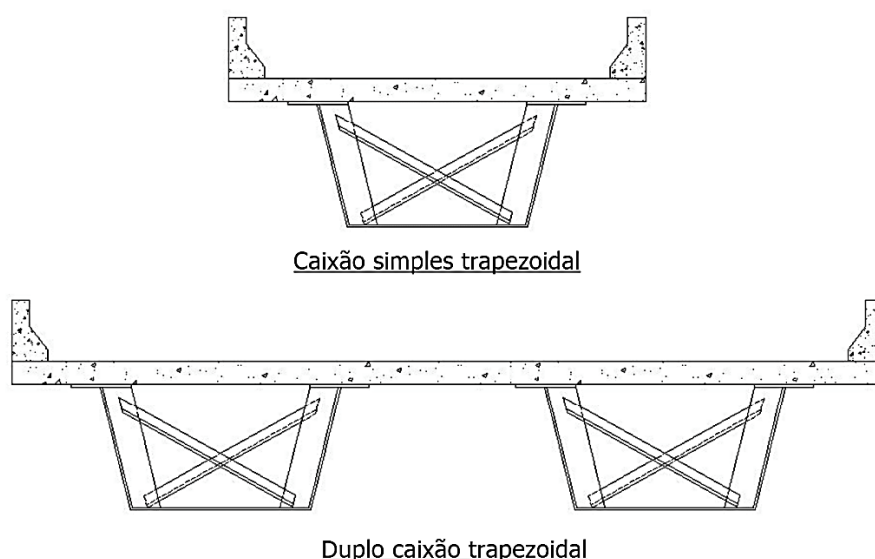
Principais seções transversais de pontes mistas de aço e concreto em seção caixão.
